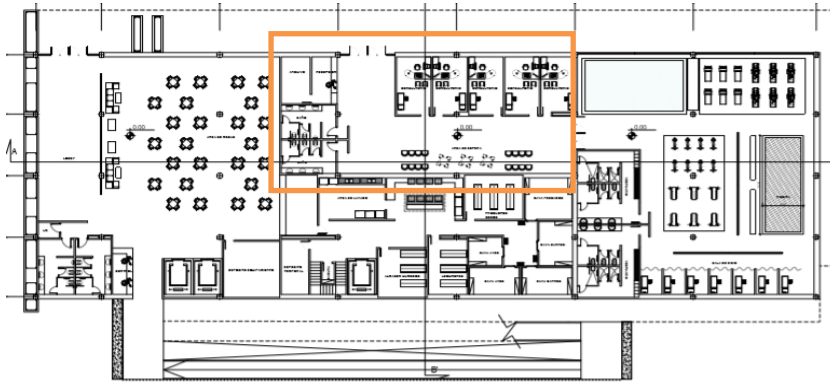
Planta Baja. Área médica. Nivel +0,00m. (2020)
